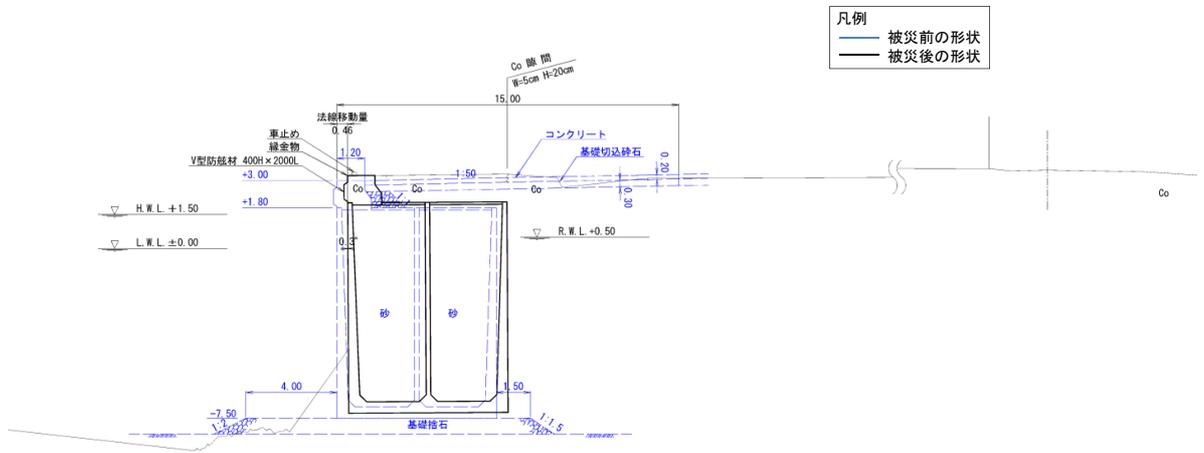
No.2 日立港区_第1ふ頭地区 1-B岸壁 (-7.5m) の断面図 (被災前・後)
